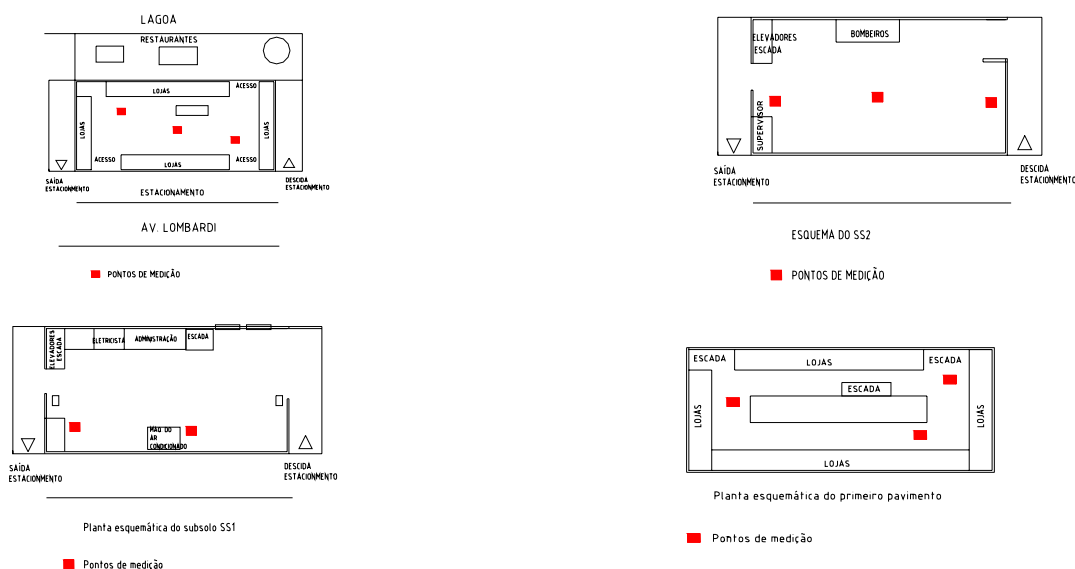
Plantas Esquemáticas do 1º andar, SS1, SS2 e térreo
